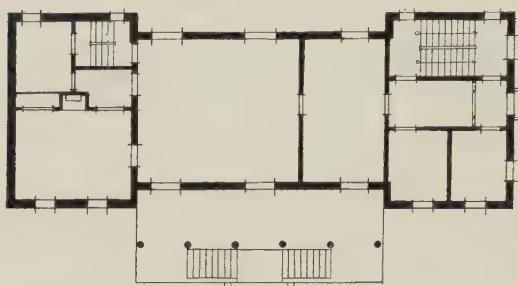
Kleines Hotel in Paris Grundriss
